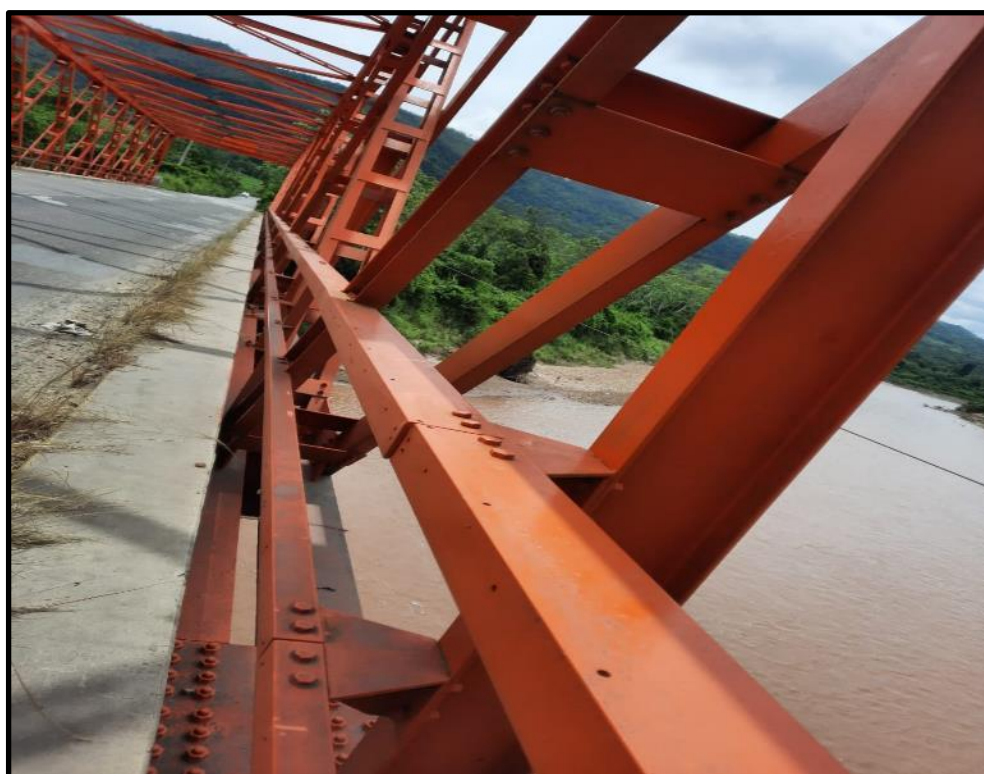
Se observa las secciones metálicas y vereda - Lado derecho
